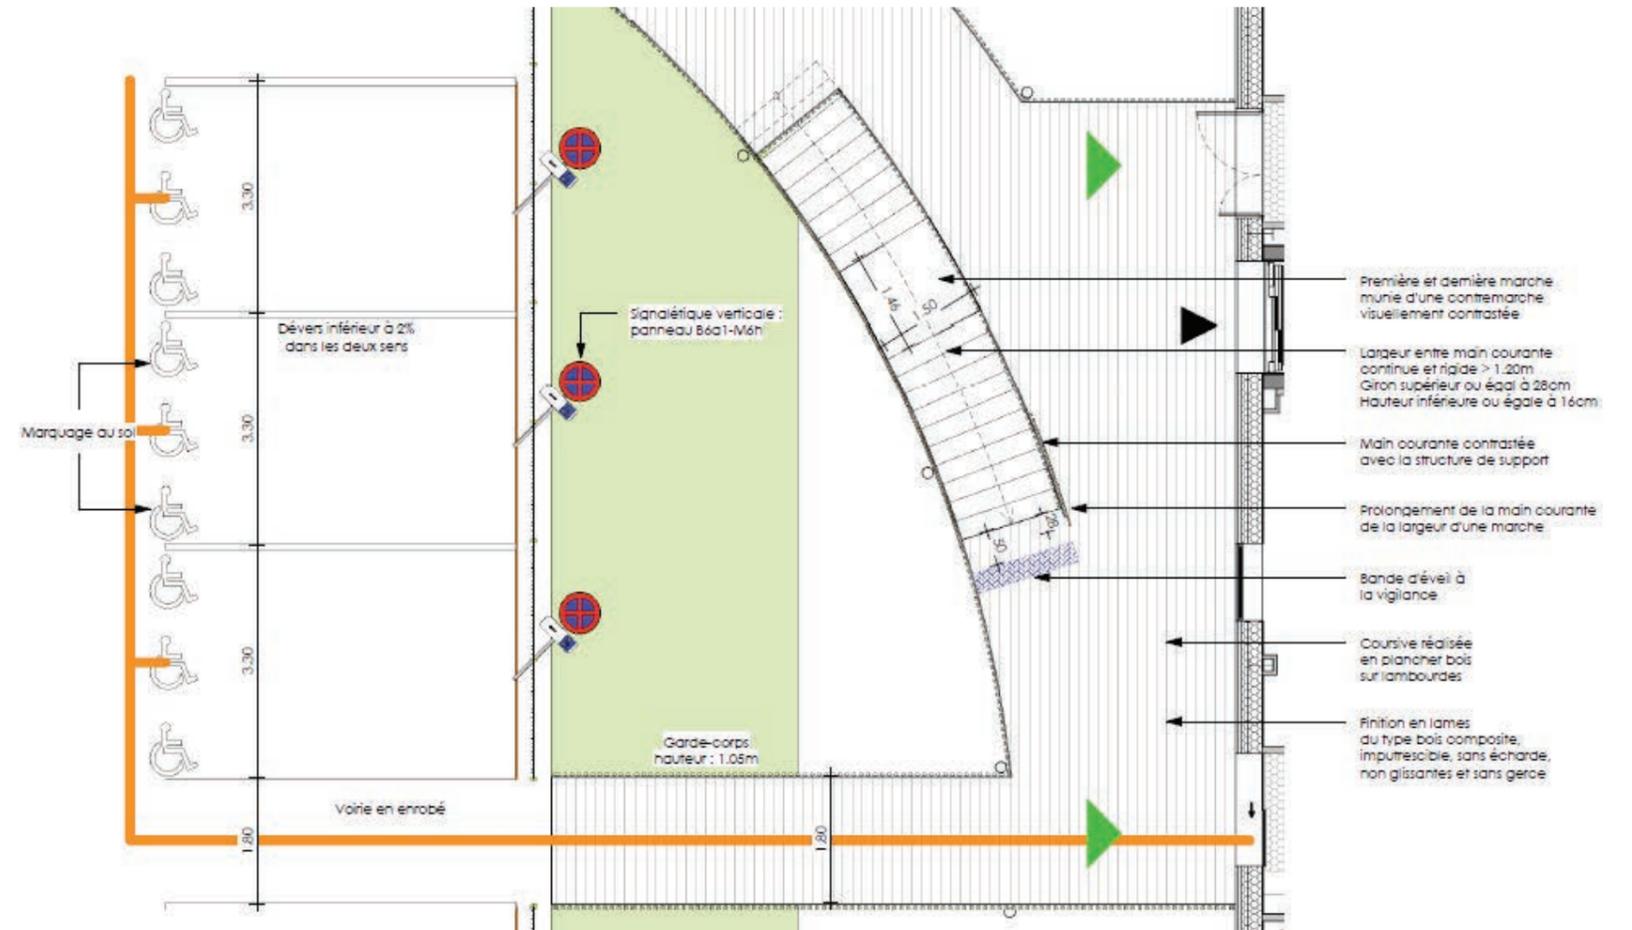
DETAILS : ACCESSIBILITE PMR (EXTRAITS)
